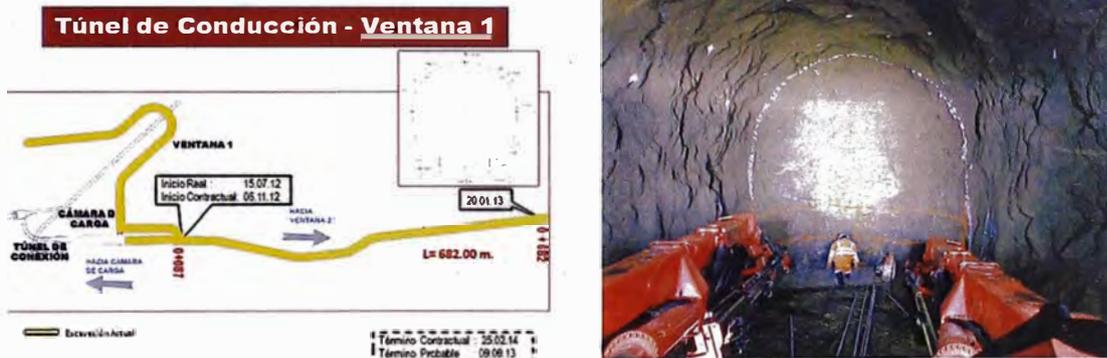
Plano e imagen del T. Conducción – Entrada (V1)
